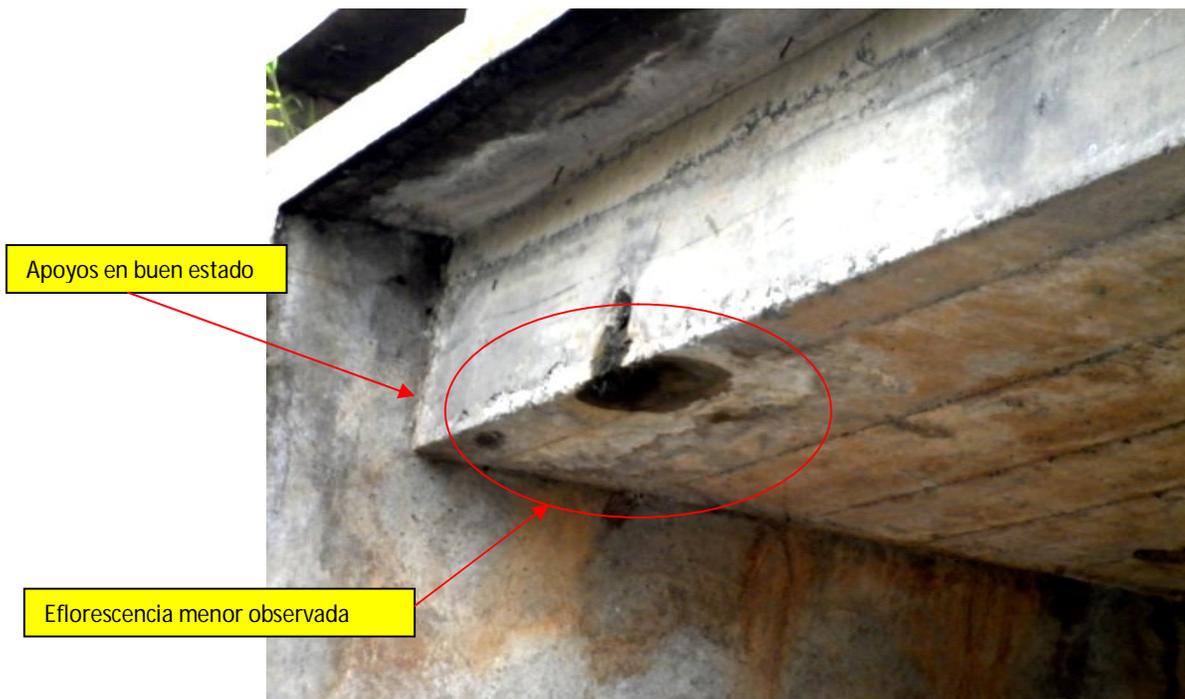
Condición de apoyo de la losa y eflorescencias en el concreto
